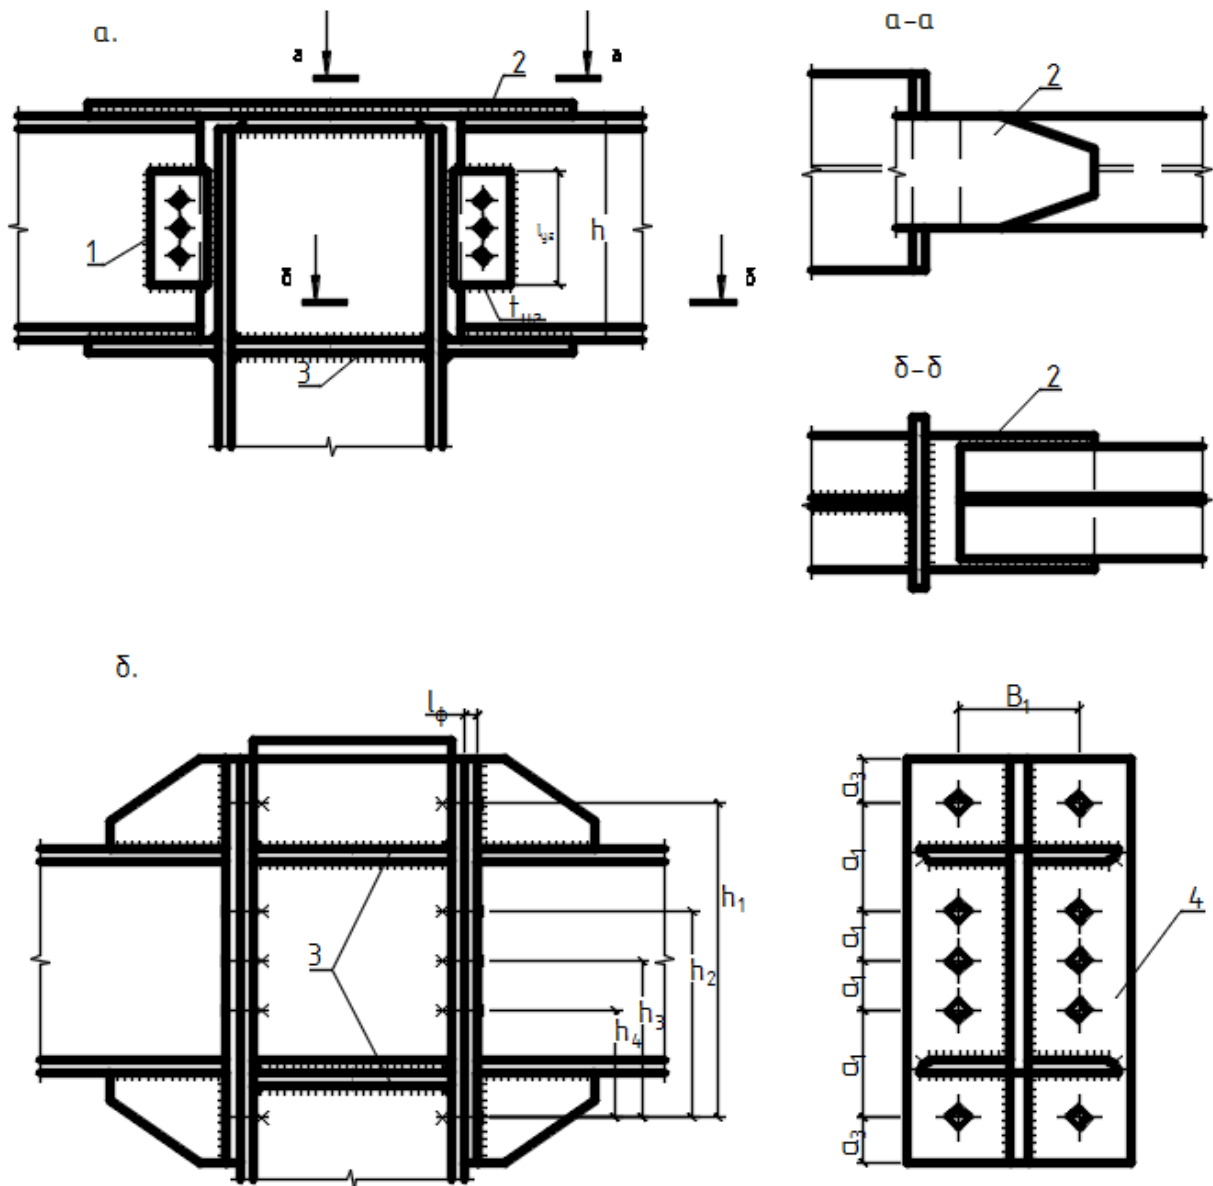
Жесткие узлы сопряжения колонн с балками: 1- вертикальное ребро; 2-горизонтальные накладки; 3- ребро жесткости; 4- опорный фланец.
